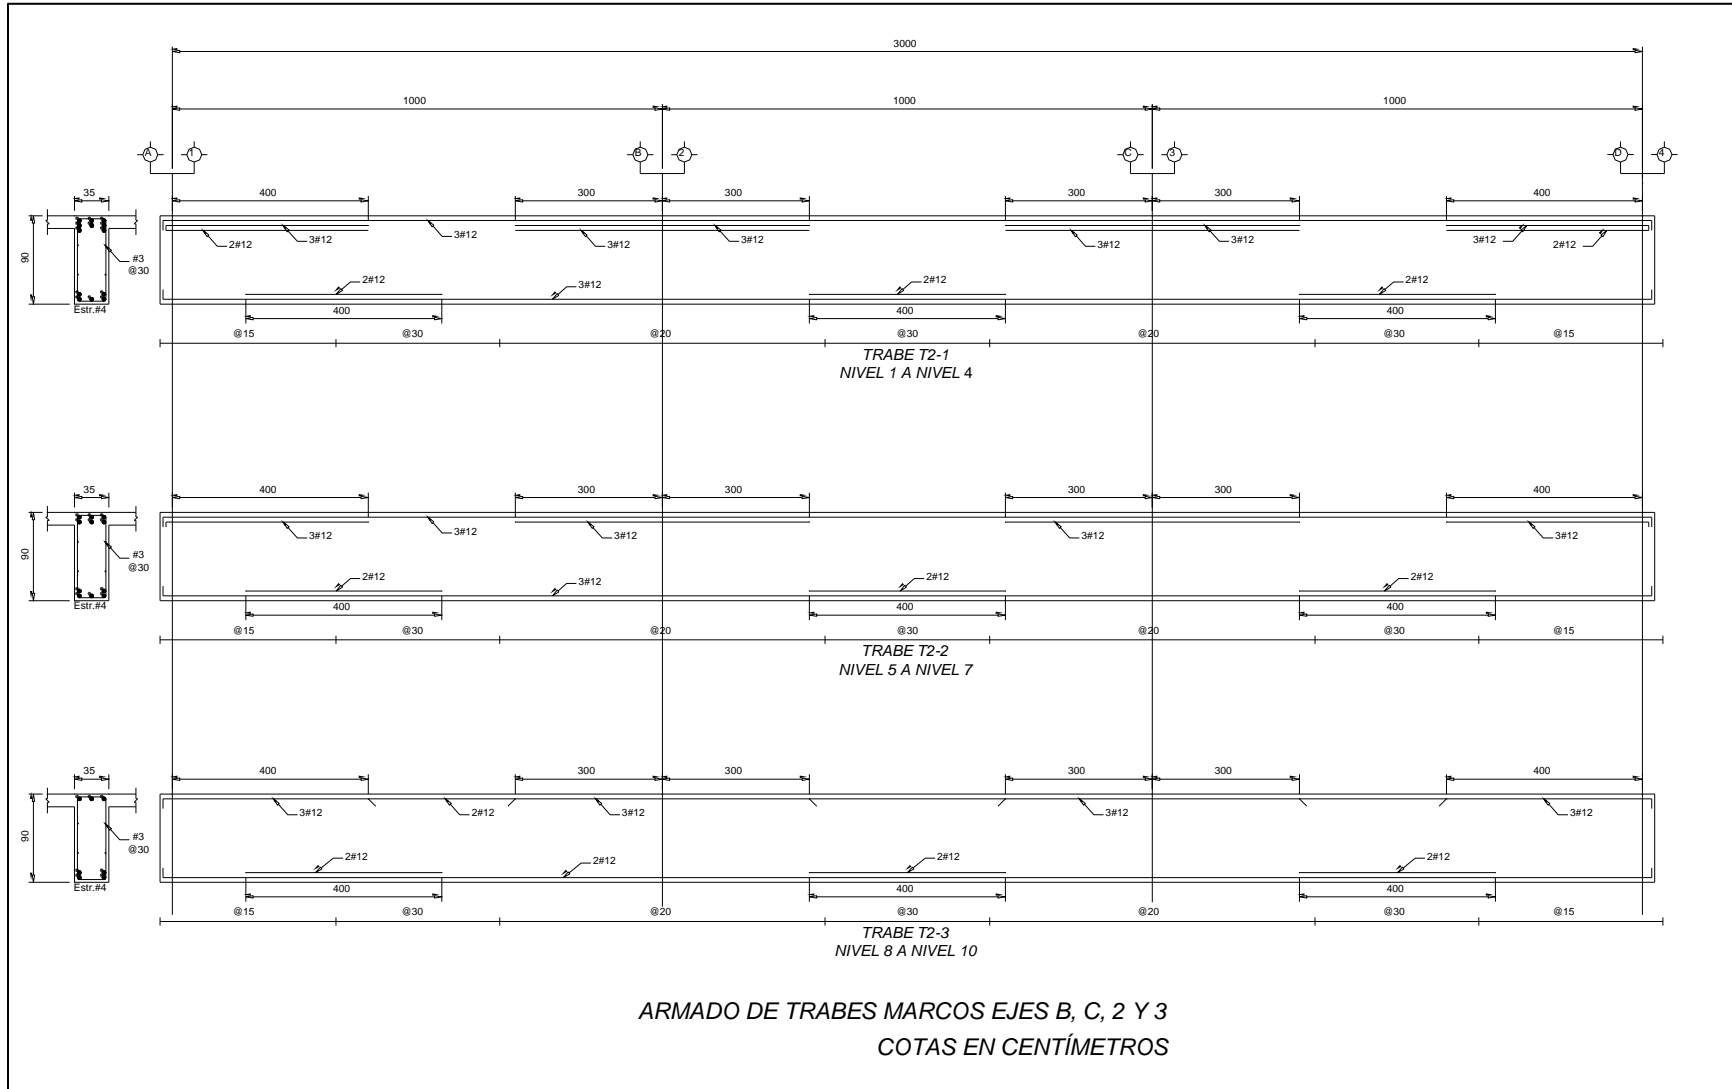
Detalles estructurales del edificio de 10 niveles diseñado con el ACI318-08
